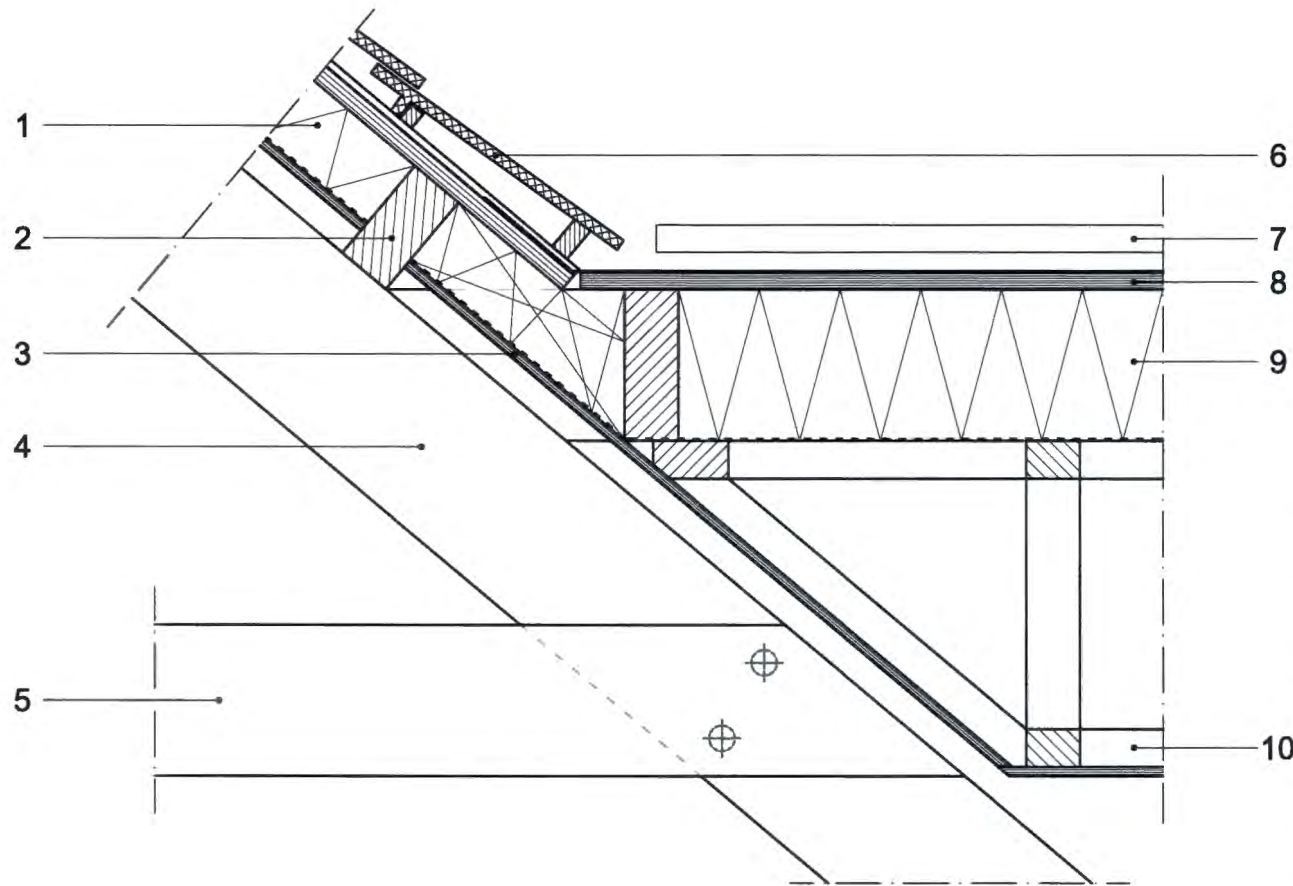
AANSLUITING ISOLATIEMETHODEN
